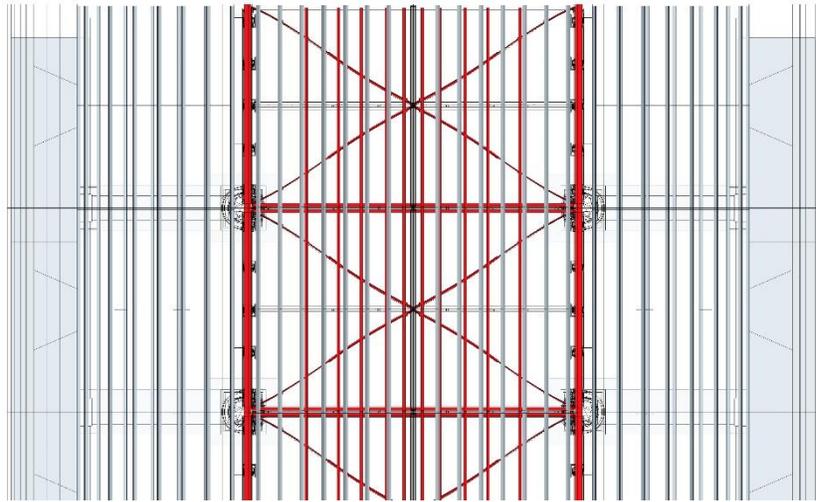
Esquema en planta de estructuras de madera en naves, en rojo, Elab. propia.
